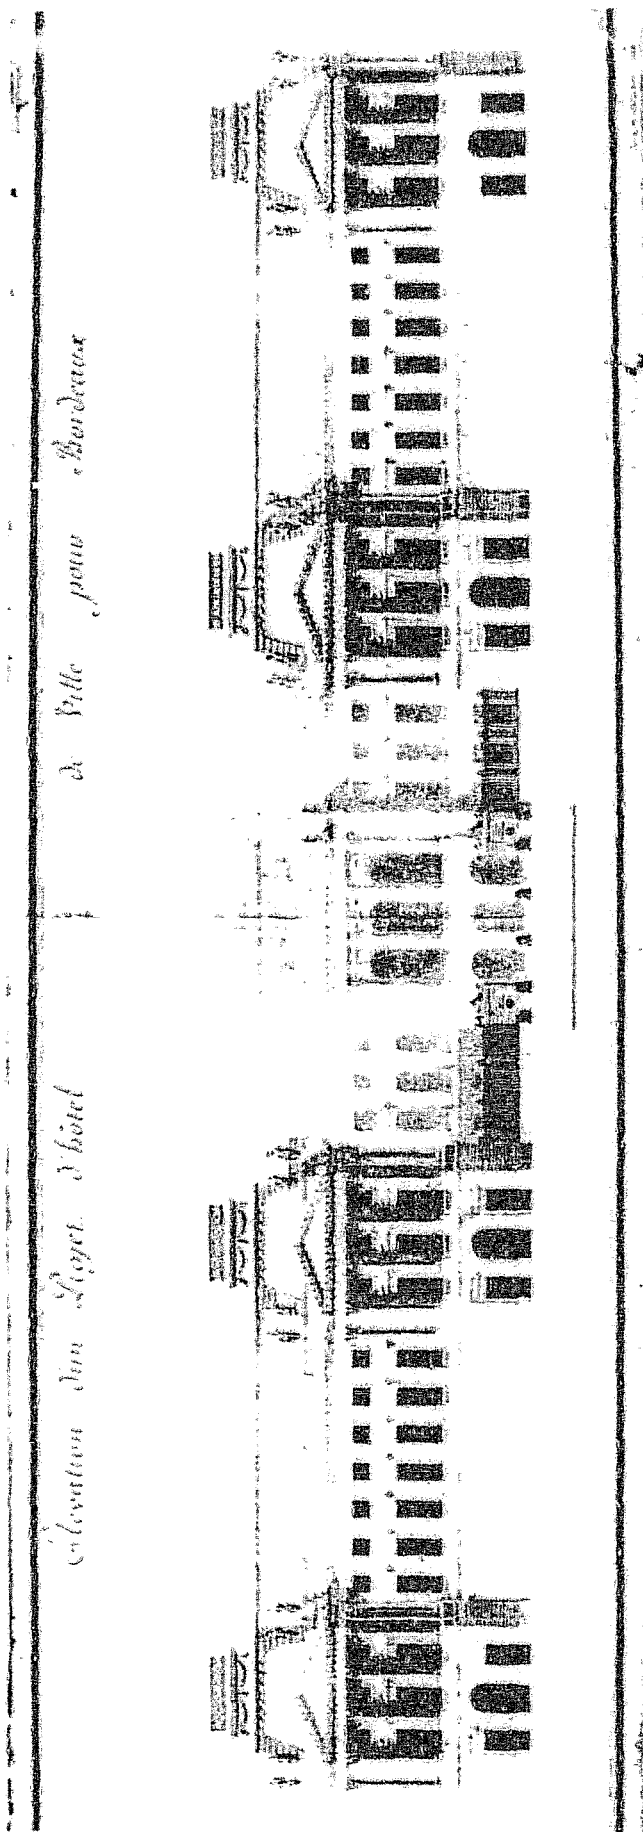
Elevation d'un projet d'Hotel de Ville pour Bordeaux . Bonfin.
